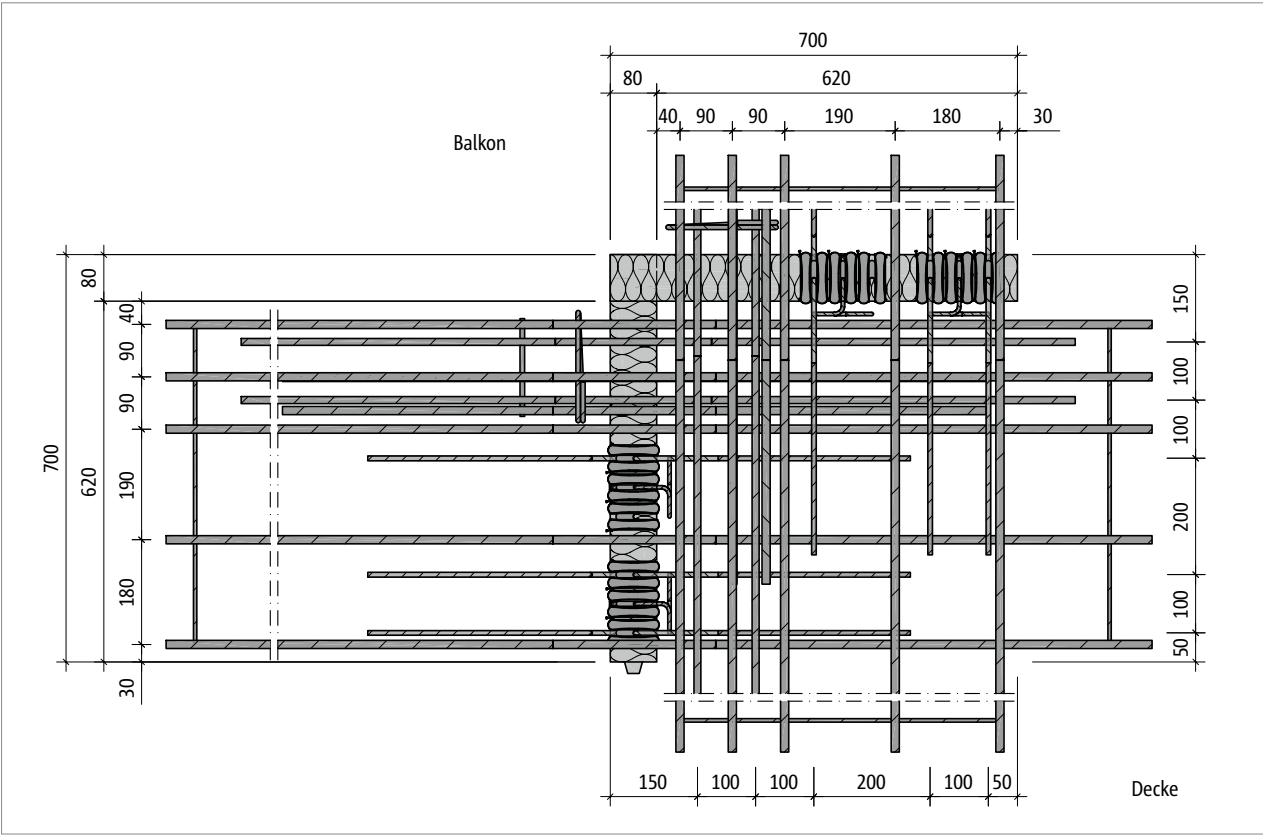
Schöck Isokorb® T Typ C-M2: Produktgrundriss
